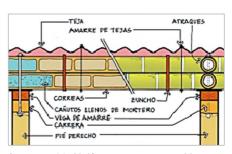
Unión entre muros y cubierta Fuente: Investigación
